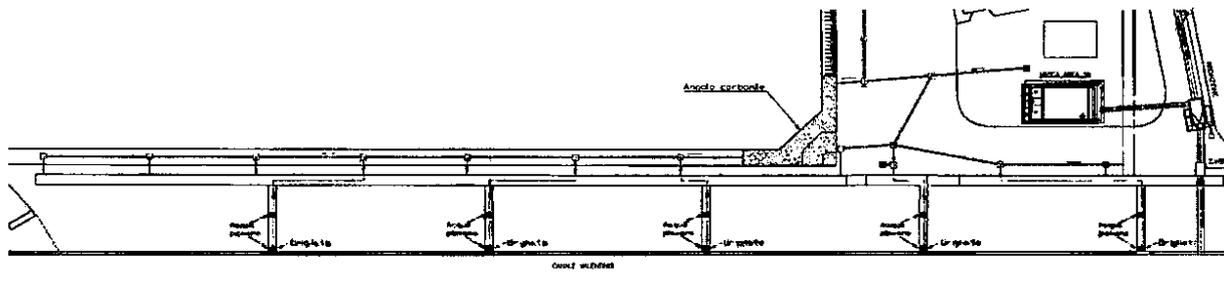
Planimetria rete fognaria banchina lato Trieste
